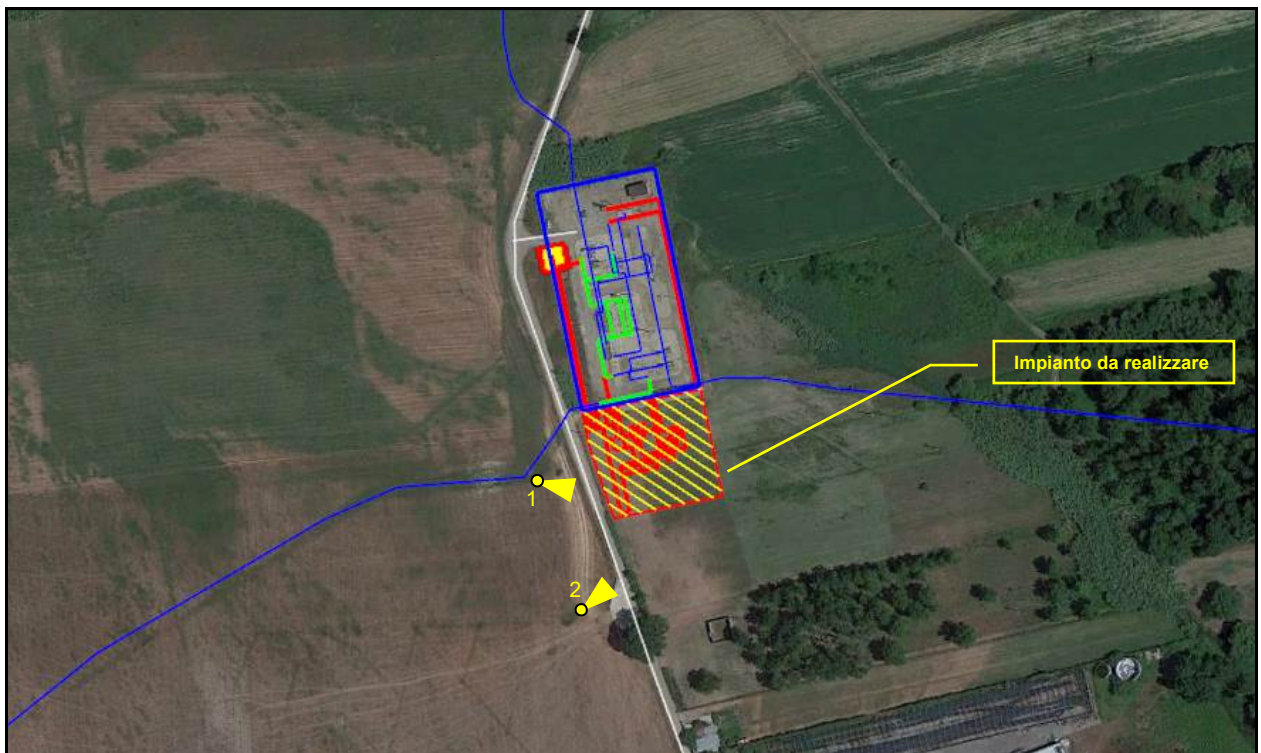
/A – Foto 2 - - Localizzazione impianto (in rosso) e recinzione Centrale di Tarsia
